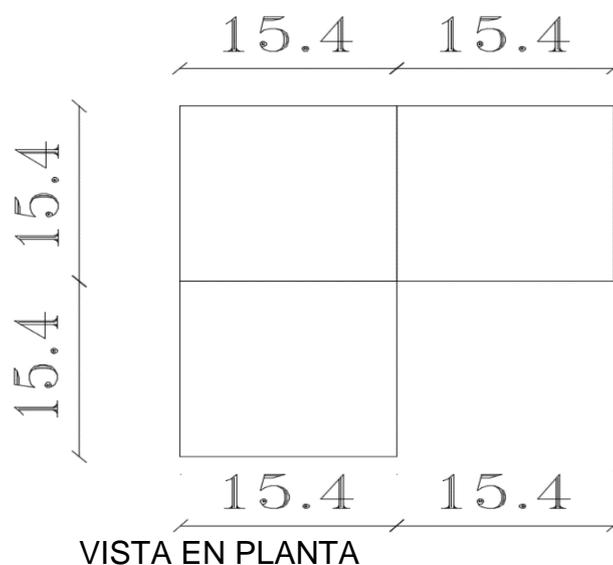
Detalle modulación en L poste a viga y vigueta de cubierta nivel +2.10m
